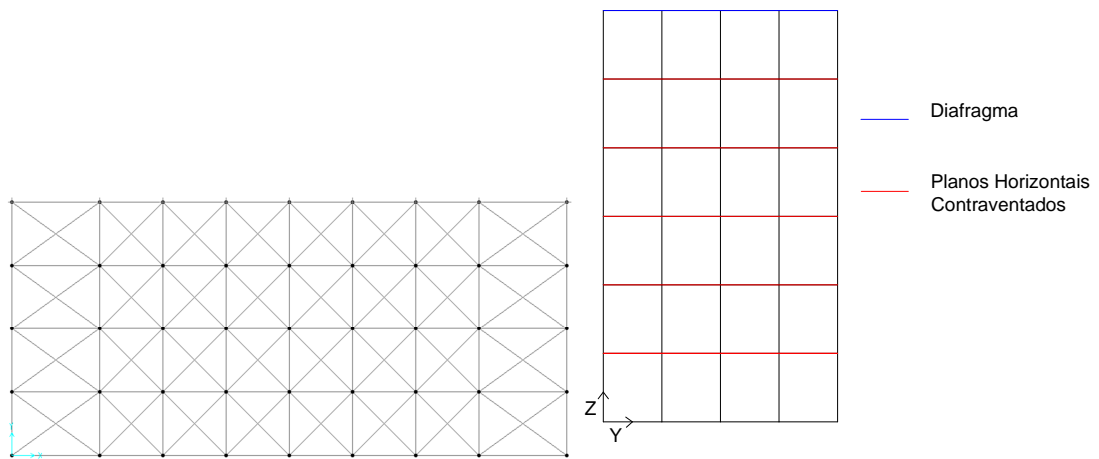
Configuração dos Planos de Contraventamento Horizontal Com Elementos de Contraventamento Pequenos
